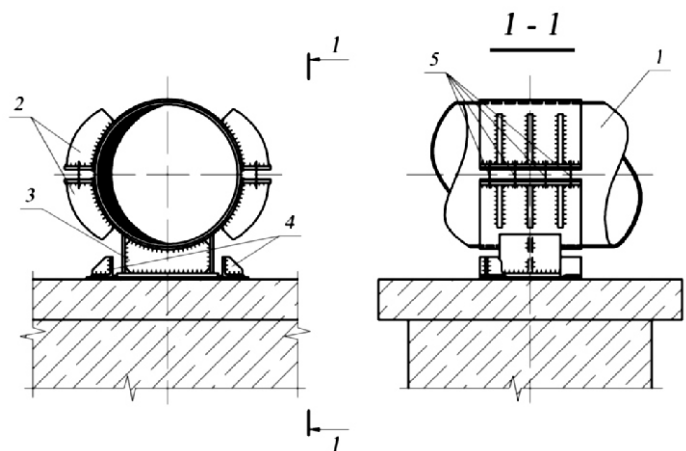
Рекомендуемый узел крепления трубы газопровода в местах опирания пилонов:
